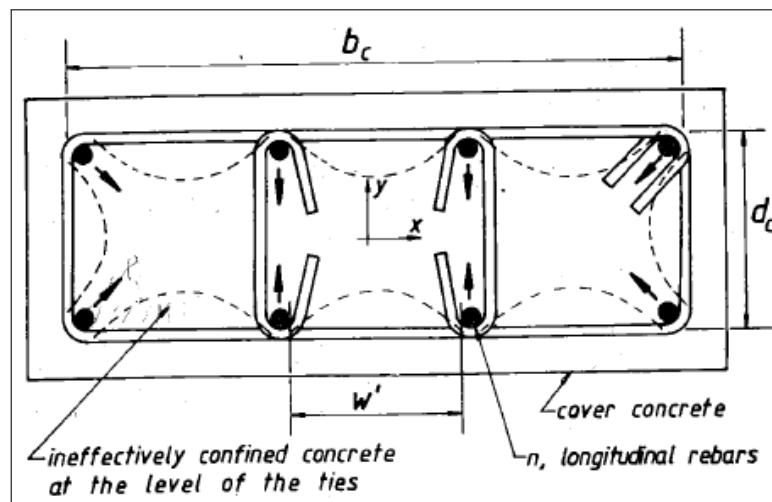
Fuerzas de confinamiento en el concreto por estribo rectangular y ramales rectilíneos.<sup>25</sup>
